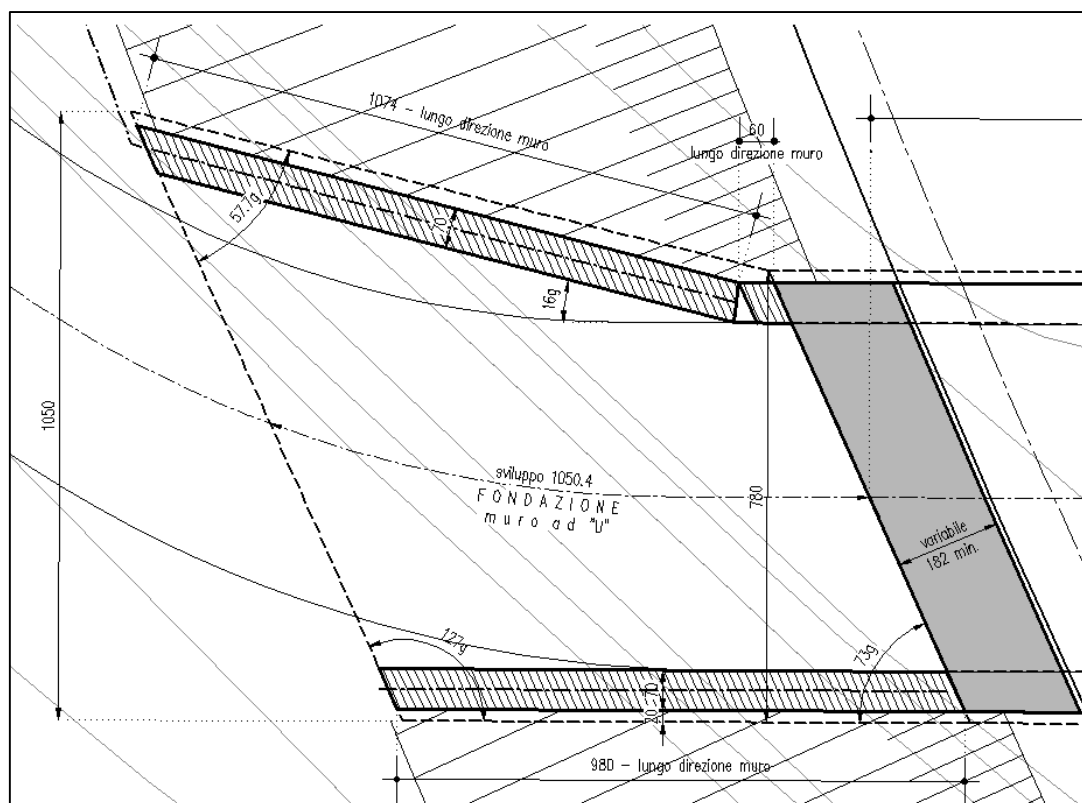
PLANIMETRIA MURI AD U IN INGRESSO SOTTOVIA PODERALE IST02
